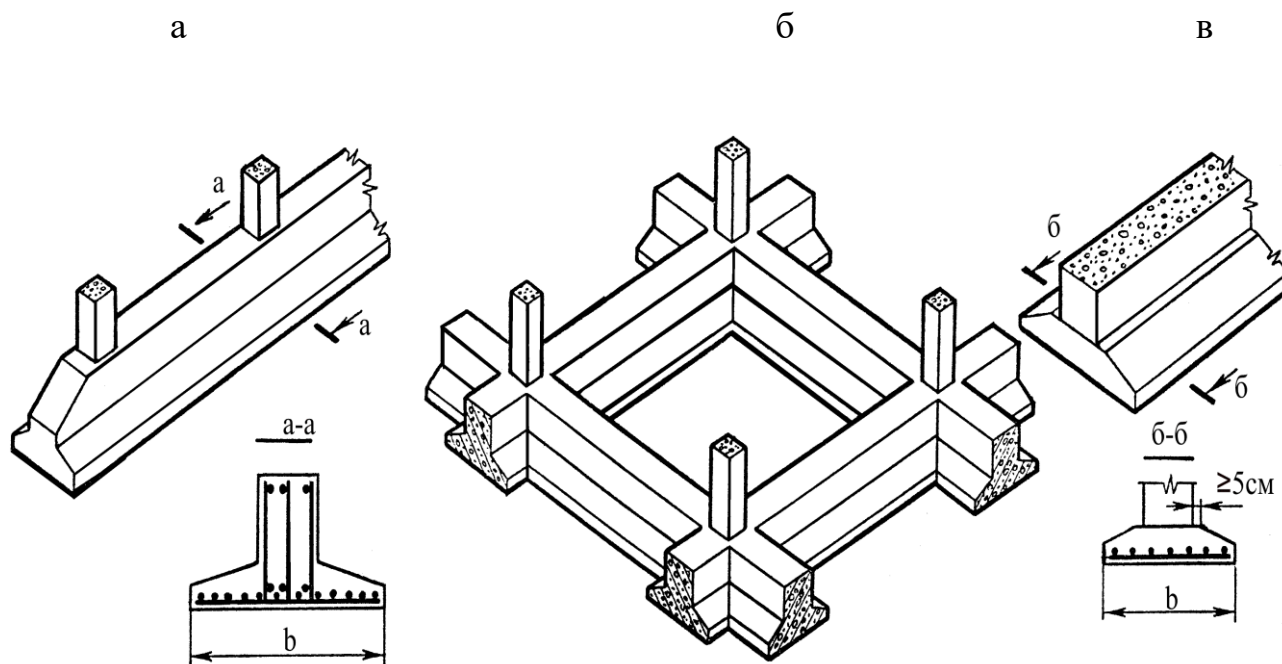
Монолітні стрічкові фундаменти: а; б) лінійний і перехресний під колони каркасних об'єктів; в) під стіну безкаркасної будівлі
